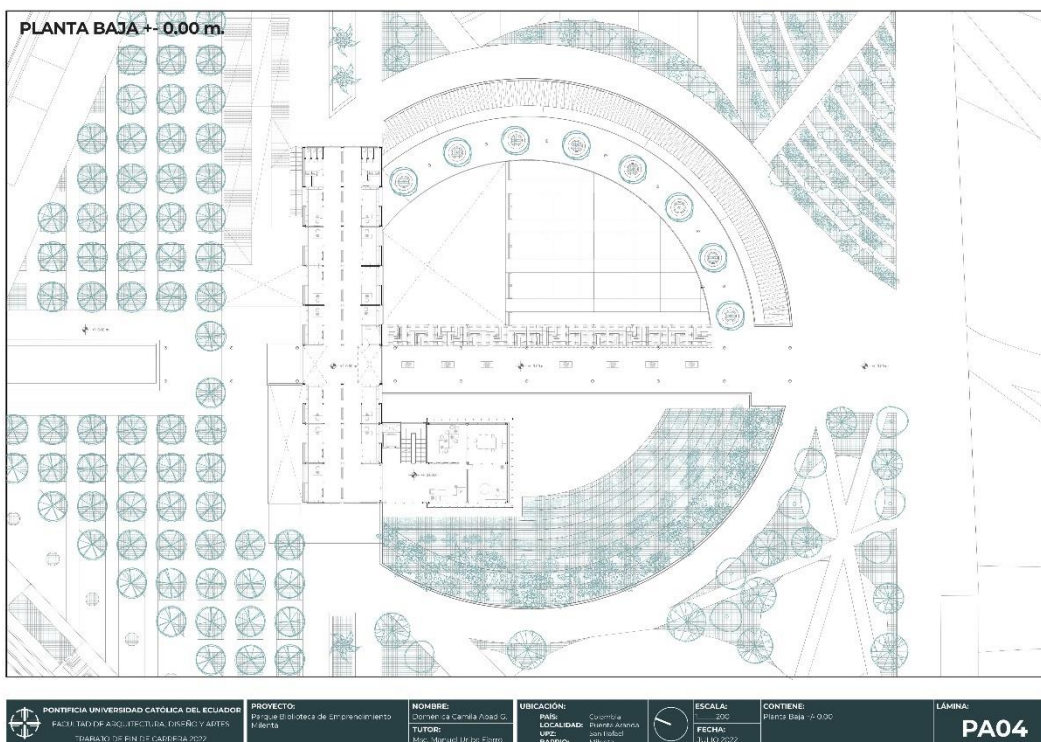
Planta Baja 0.00m (Abad,D. 2022)
